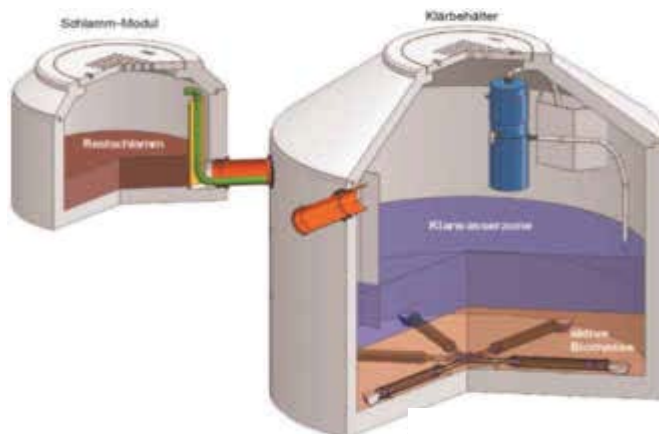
Kleinkläranlage; Einbeckenkläranlage für 4 bis 50 Einwohner nach dem Belebtschlammprinzip im Aufstauverfahren mit Schlamm-speicher ohne Trennwand
